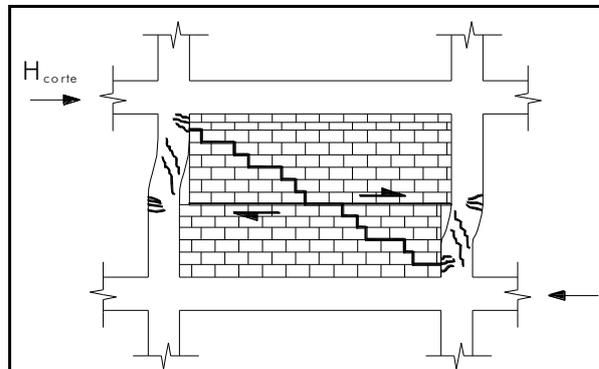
Rotura por corte do painel de parede de alvenaria.
